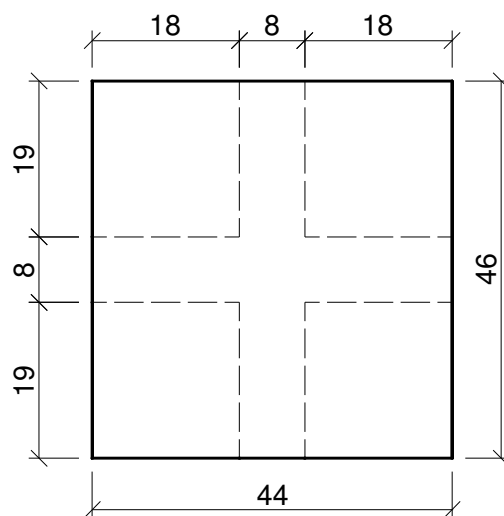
Área da laje a ser considerada para cálculo do peso próprio.
